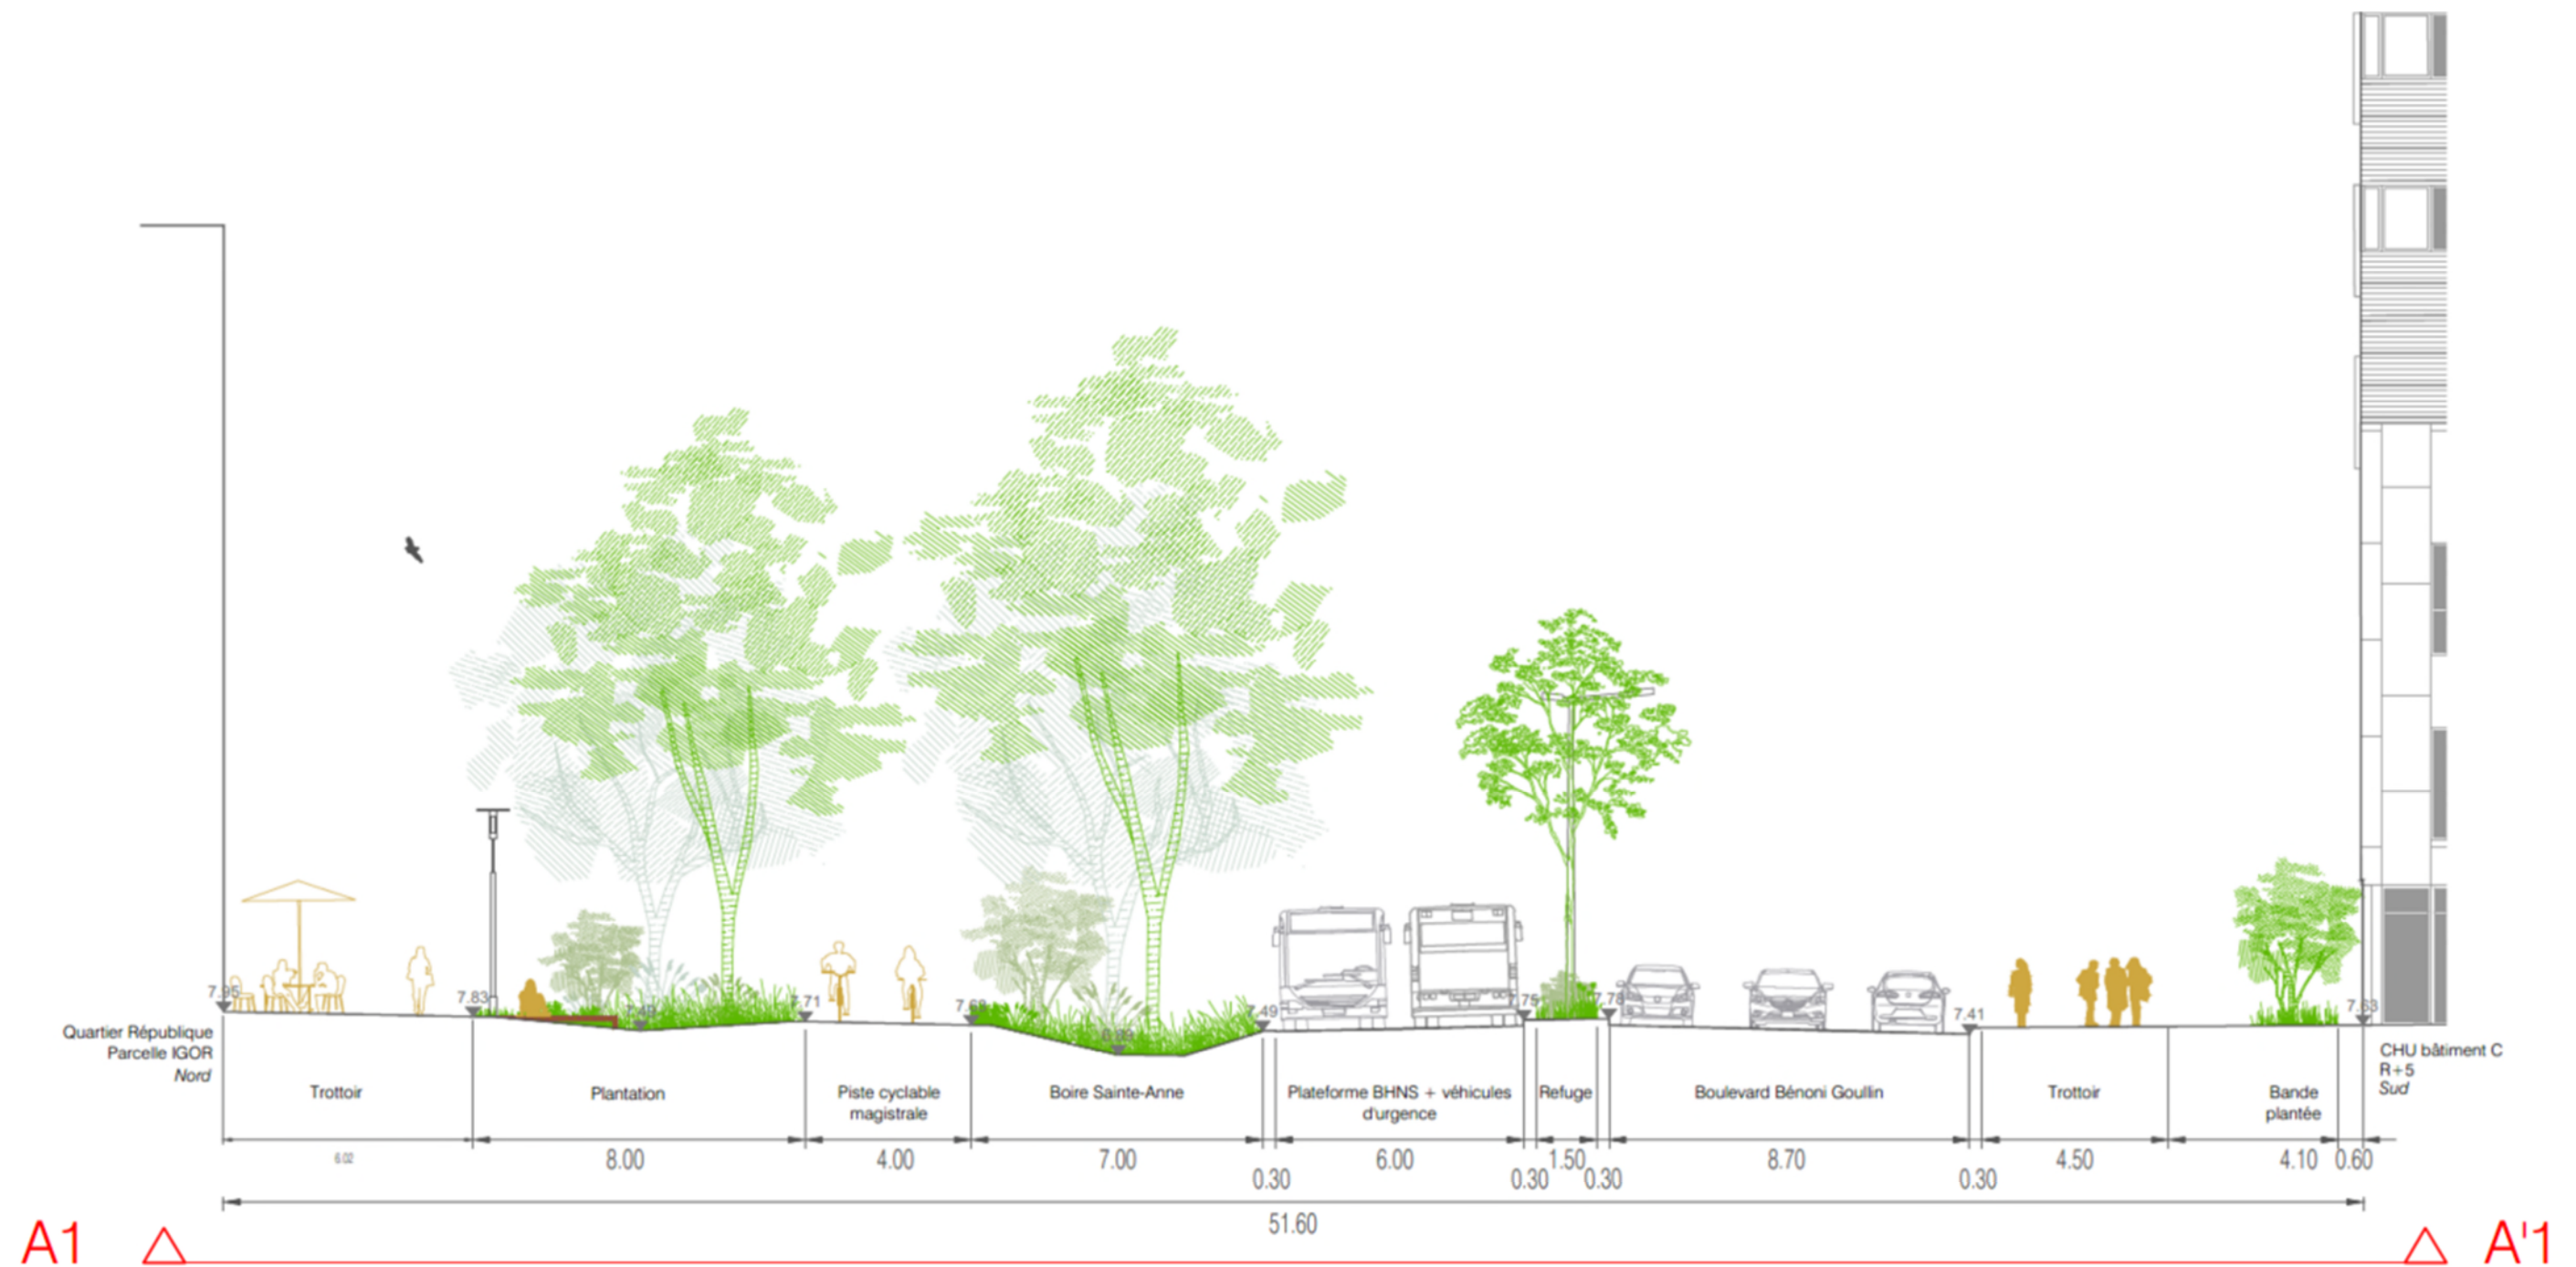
Coupe type de l'aménagement boulevard B Goullin au droit du CHU
